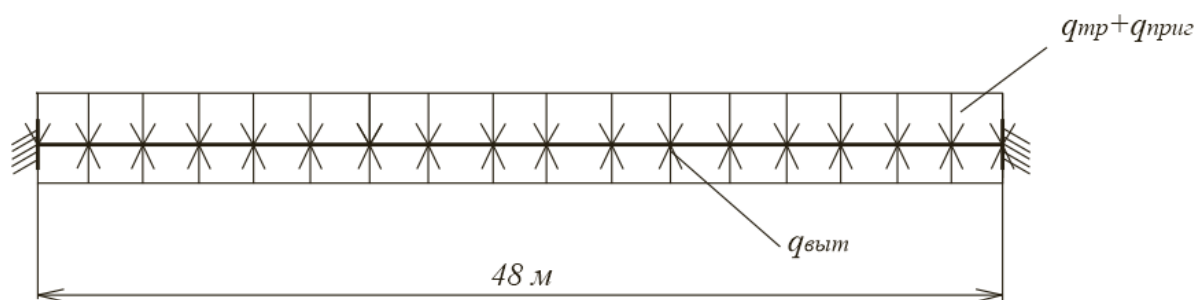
Расчетная схема трубопровода с пригрузом типа УЧК
